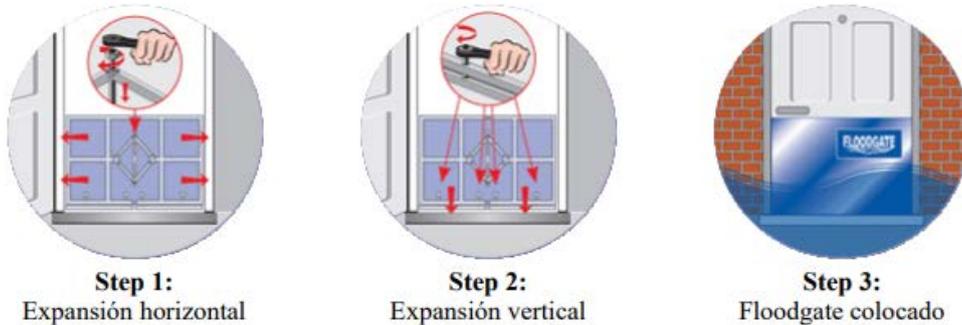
Barrera temporal tipo floodgate en puertas de la fachada oeste.
